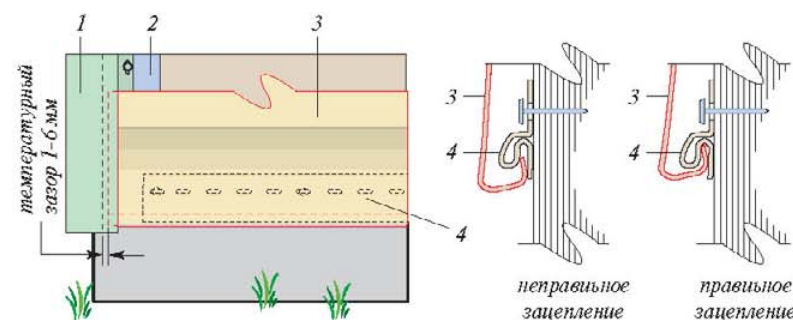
Установка первой рядовой панели сайдинга: 1 — угловой профиль; 2 — подложка (гидроизоляция) из кровельной жести; 3 — рядовая сайдинговая панель; 4 — стартовый профиль
